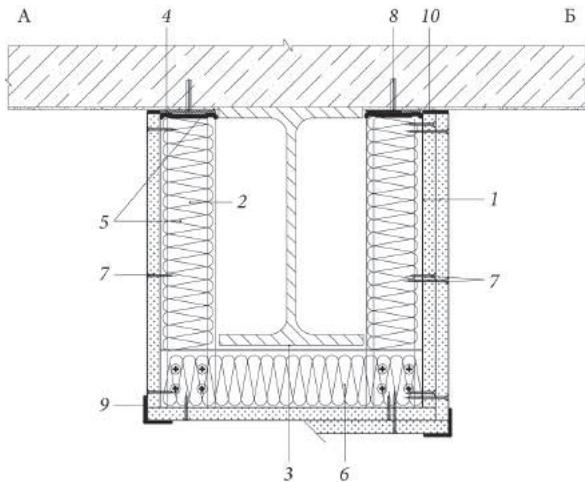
Облицовка фахверковой колонны: А — однослоиная обшивка; Б — двухслойная обшивка; 1 — ГКЛО; 2 — теплоизоляция (минераловатные плиты или маты); 3 — колонна; 4 — уплотнительная лента; 5 — ПС-профиль; 6 — ПН-профиль, соединенный с ПС-профилем стенка к стенке; 7 — шуруп; 8 — быстрофиксирующий гвоздь; 9 — угловой защитный профиль с последующим шпаклеванием; 10 — герметик
